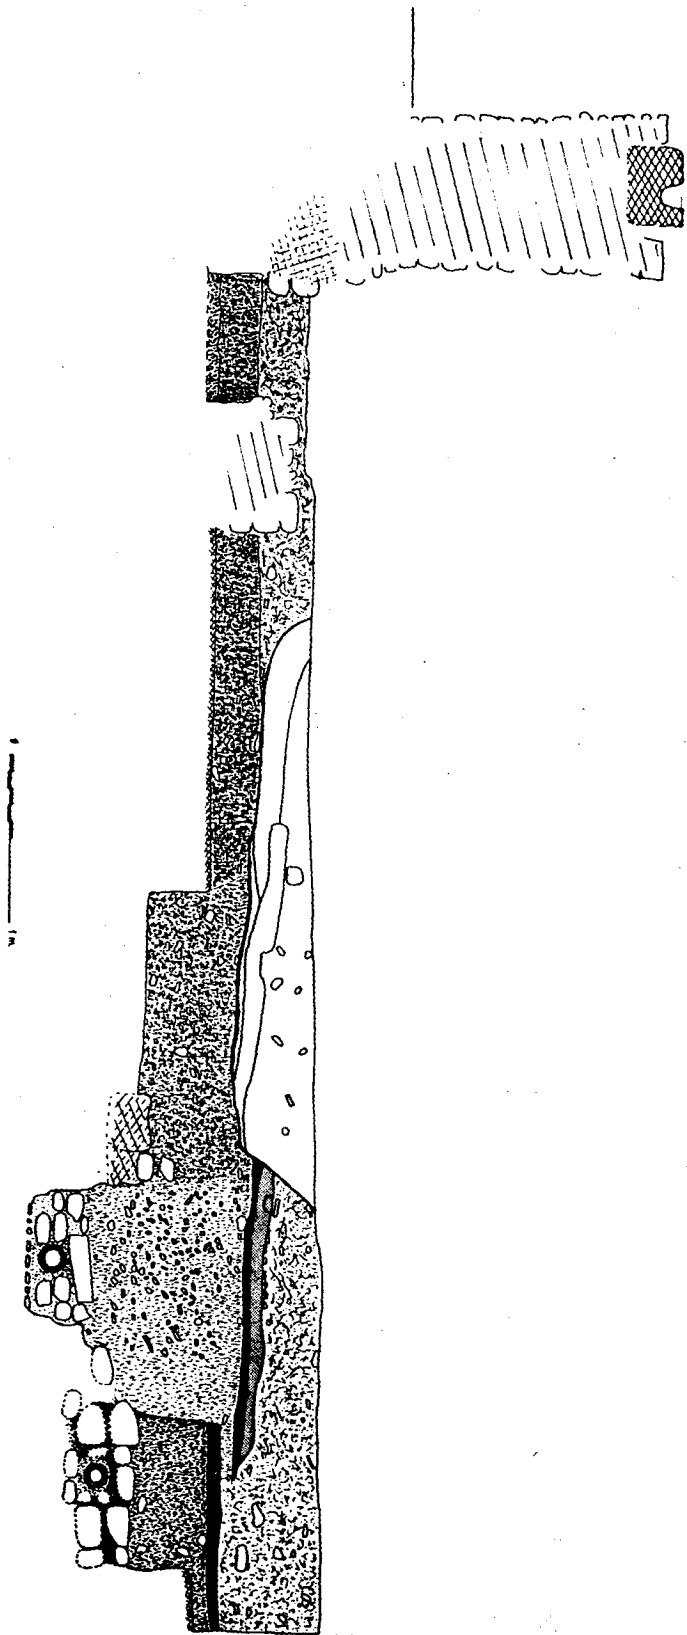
Planta huerta. Conducciones forzadas en tubos cerámicos y en car. 1' abierto.
